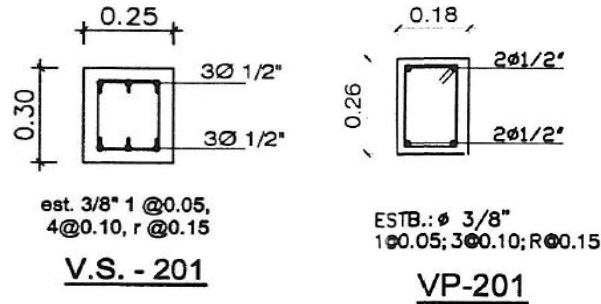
Revisión de detalles de las vigas de los planos de la estructura de la institución educativa N° 10386.
